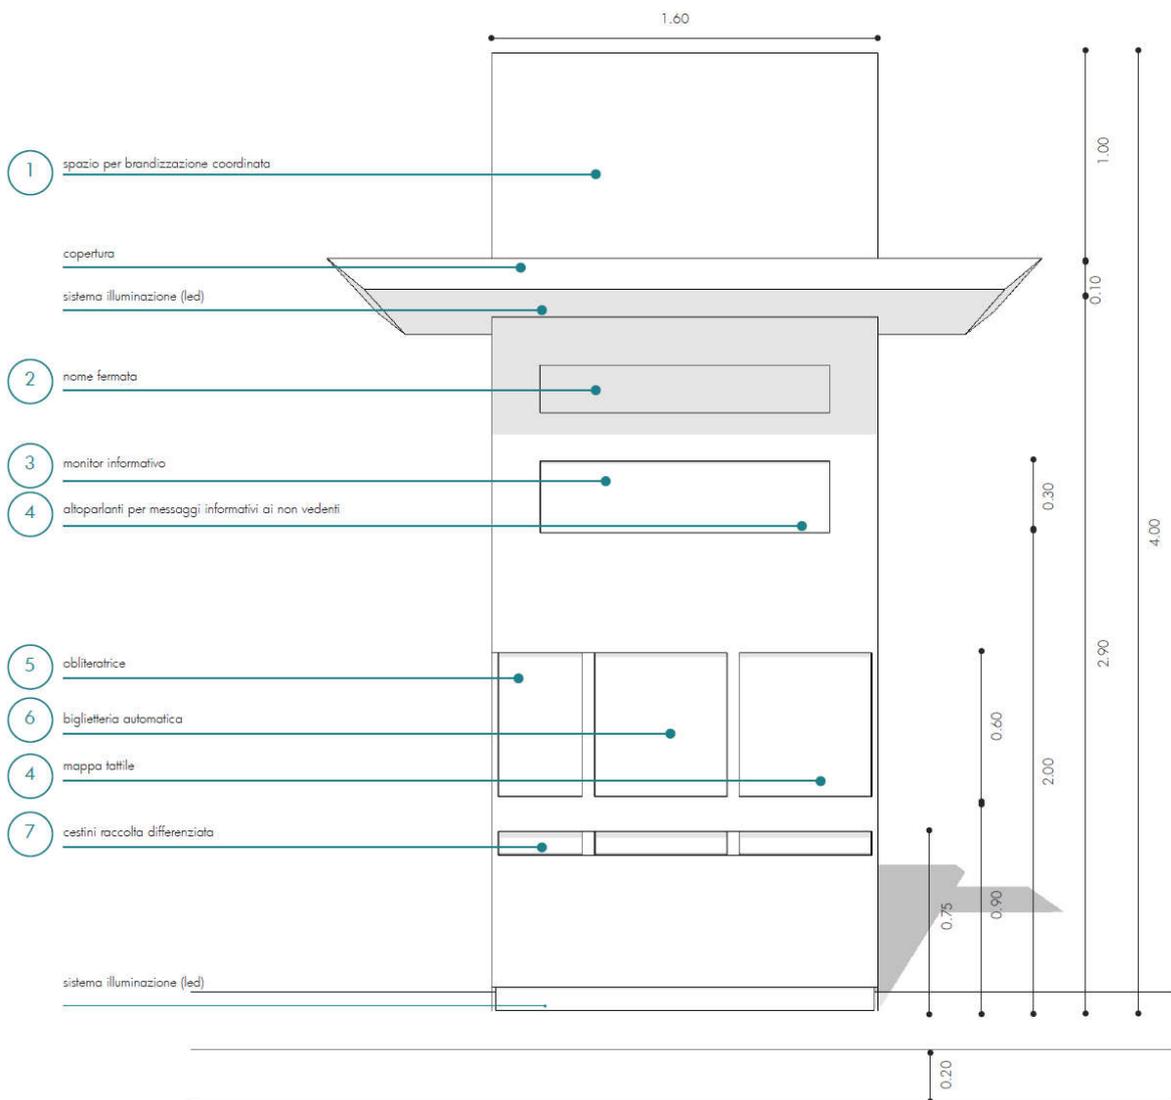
Tipologia 1 Minimal. Prospetto frontale.
